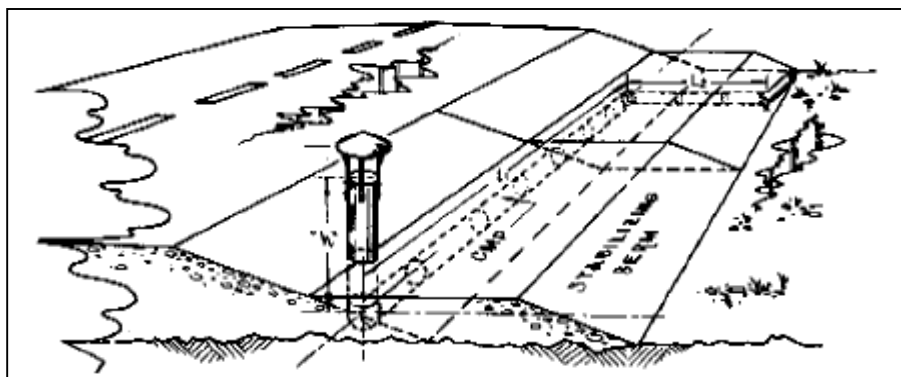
Installation de cheminées sur des systèmes de ventilation parallèles à la piste (Zarling et coll., 1984)
